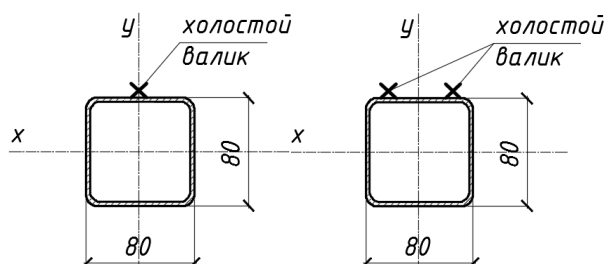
Схемы наплавки одного и двух холостых валиков по одной из главных осей стальных конструкций из труб квадратного сечения
